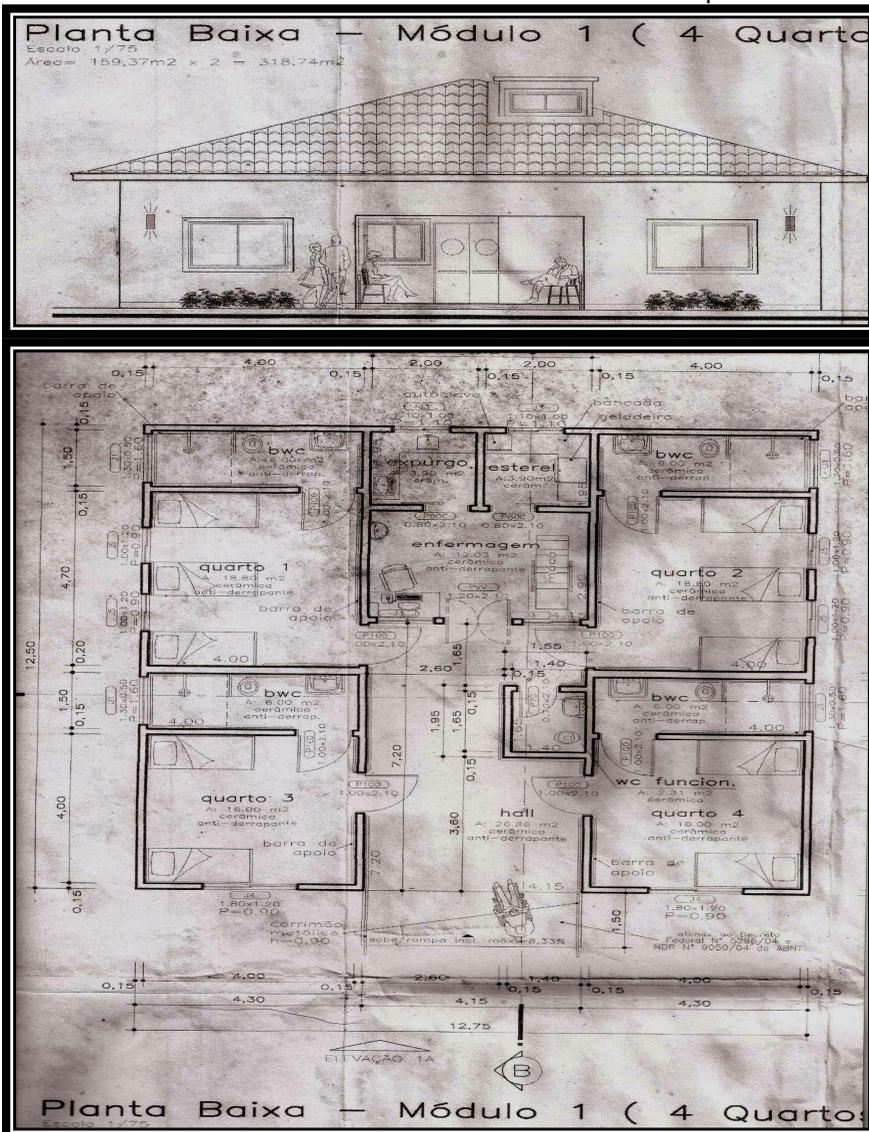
Perspectiva/Planta Baixa do Módulo Habitacional Tipo 1
